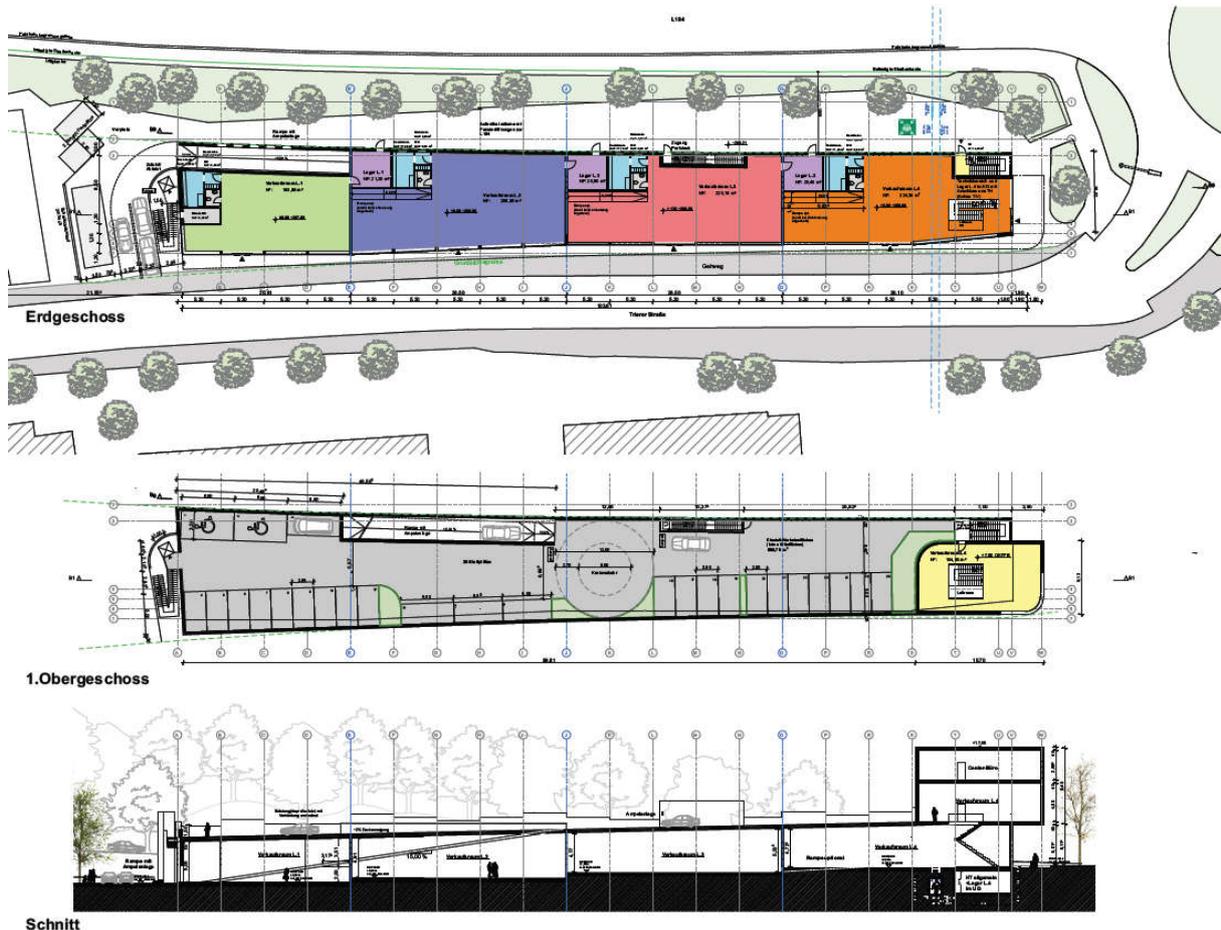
Entwurf „Neubau Zimmerei-Outlet-Store“
